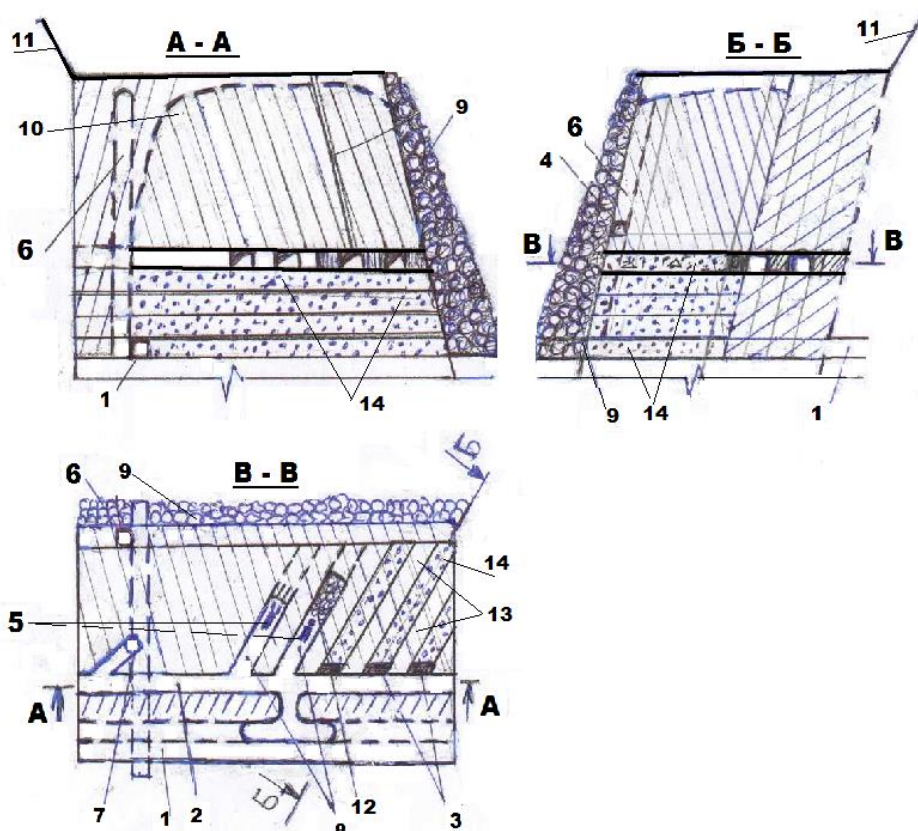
Способ отработки прибортовых запасов с закладкой при комбинированной разработке месторождений: 1-откаточный штрек, 2- слоевой штрек, 3- бетонные перемычки, 4- закладочно-вентиляционный штрек, 5- буровые и погрузочно-доставочные оборудования, 6- вентиляционно-закладочный восстающий, 7- рудоспуск, 8- очистные заходки, 9- внутрикарьерный отвал забалансовой руды, 11- уступ карьера, 12- обрушенная руда, 13- рудный целик между заходками, 14- закладочный массив.
